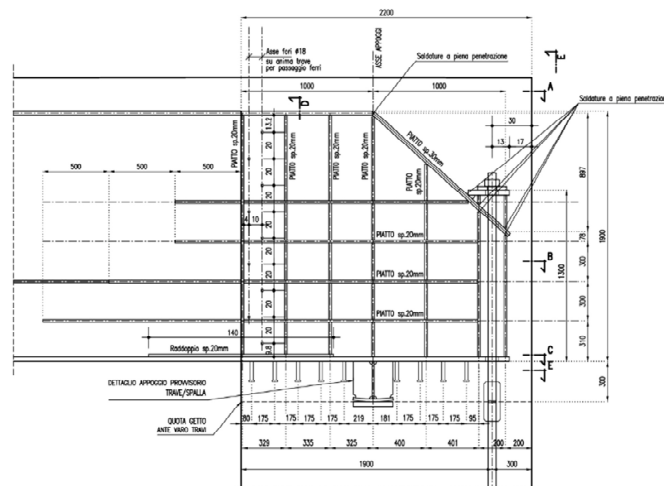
Dettaglio carpenteria metallica nodo spalla-impalcato
